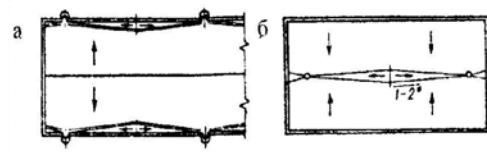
Водовідвід з дахів і покриттів будівель (плани): а – зовнішній організований; б – внутрішній
